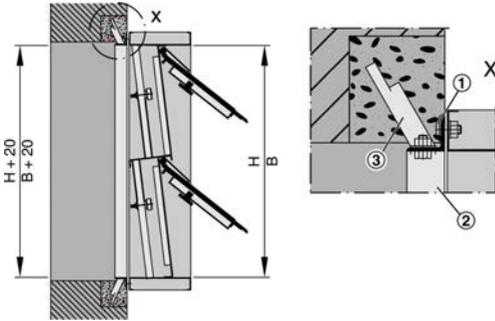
Wandanbau mit Einbaurahmen (Stahl-/Edelstahl-Ausführung)
